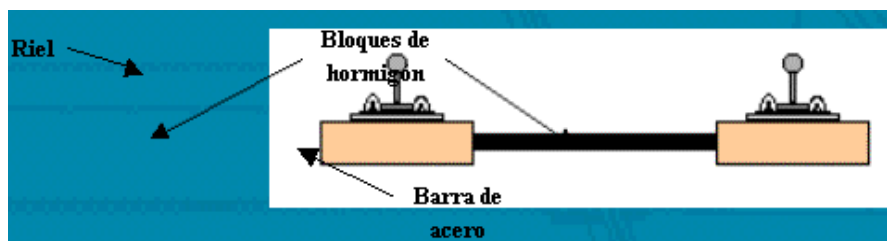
DURMIENTE MIXTO DE ACERO Y DE HORMIGÓN
